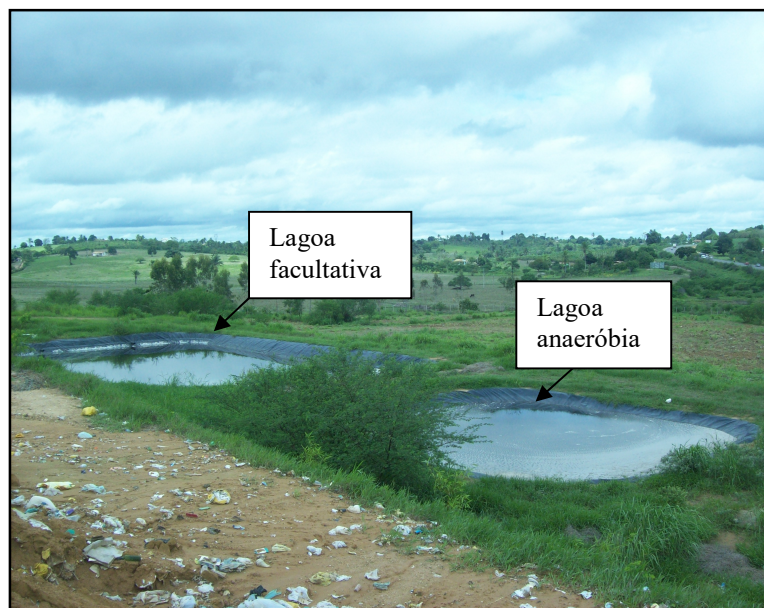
Lagoas de Estabilização – Aterro Sanitário de Cruz das Almas/BA
